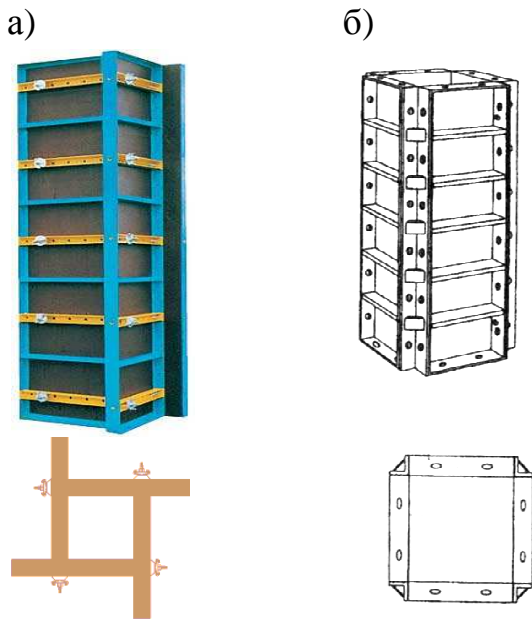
Опалубка колон фірми «Даллі»:
